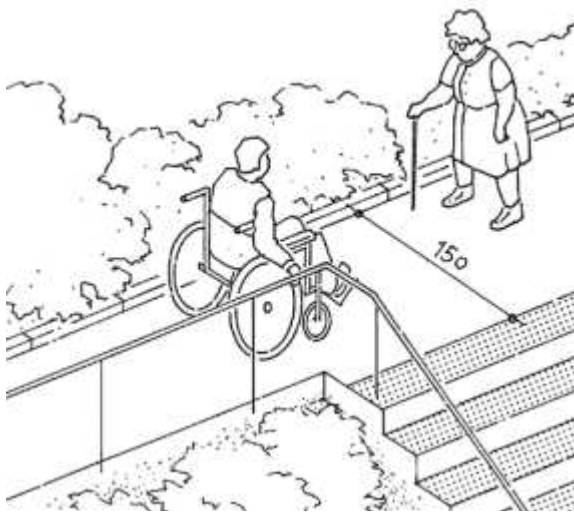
Bewegungsfläche neben Treppenauf- und -abgängen
